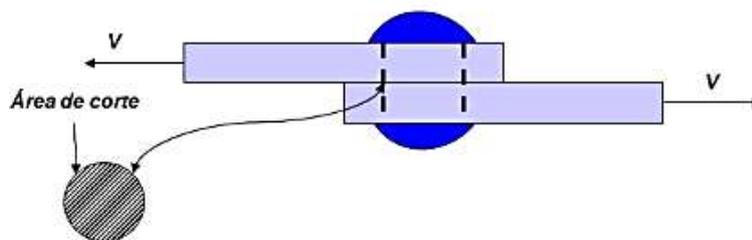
Sección transversal Fuente: (Pineda Silva, 2015.)
